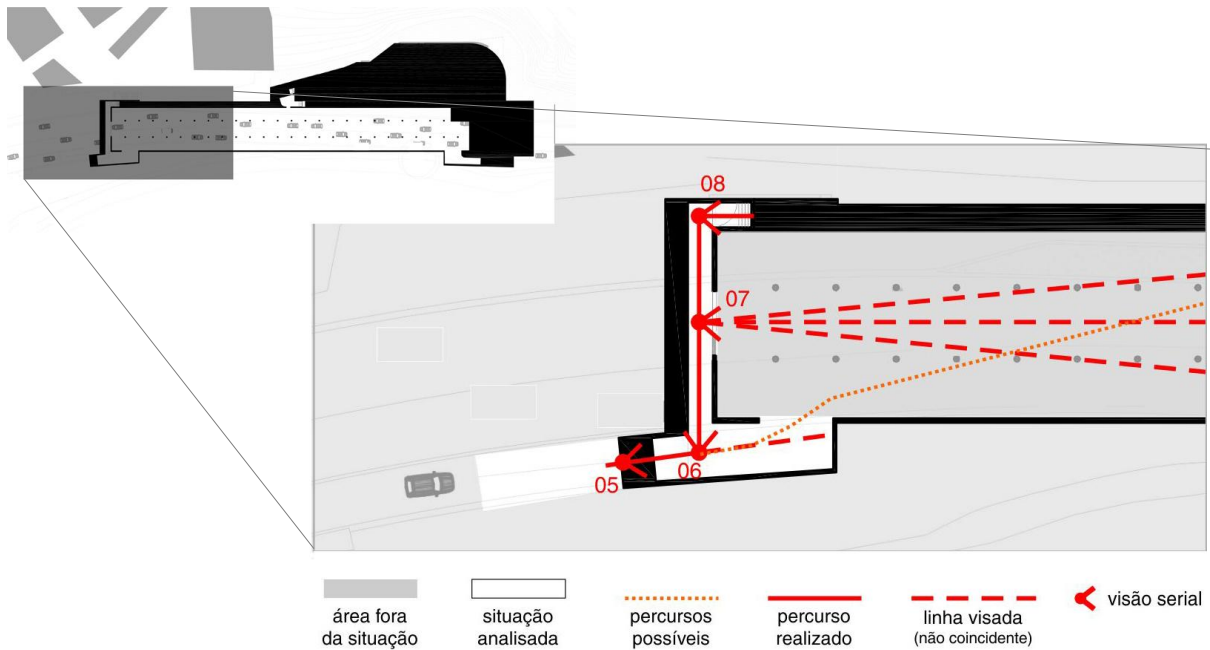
| FIC – Planta Subsolo | Desenho da Autora
